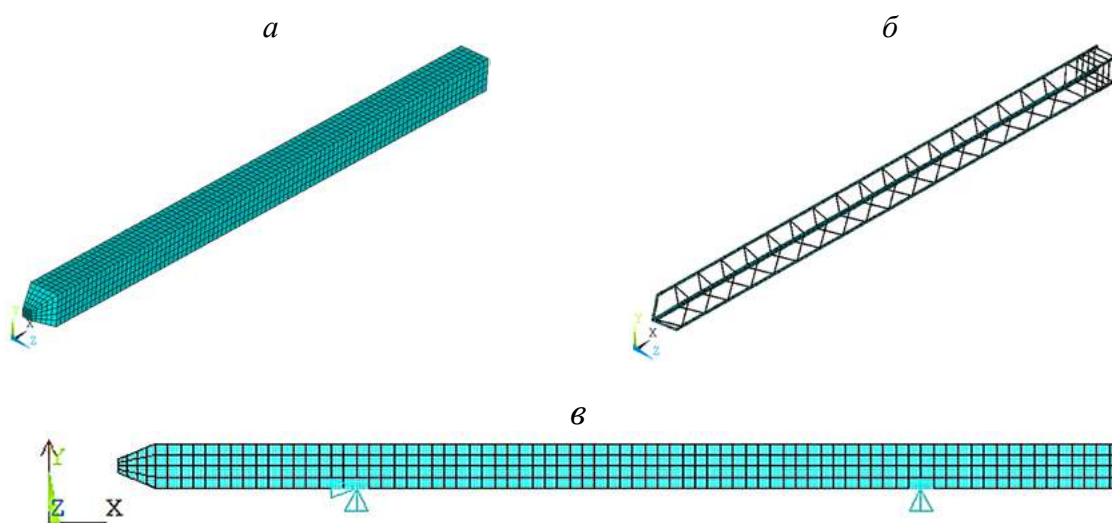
Конечно-элементная модель армированной сваи: *а* — бетонная свая; *б* — арматура; *в* — граничные условия
